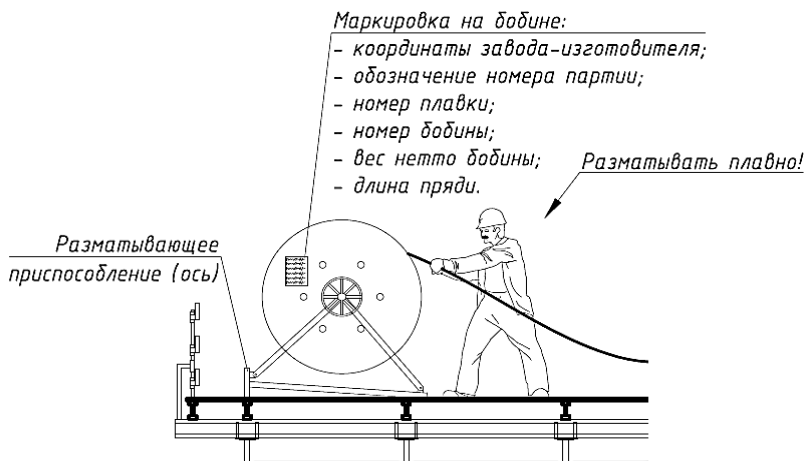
Разматывающее приспособление для бобин с арматурными канатами
